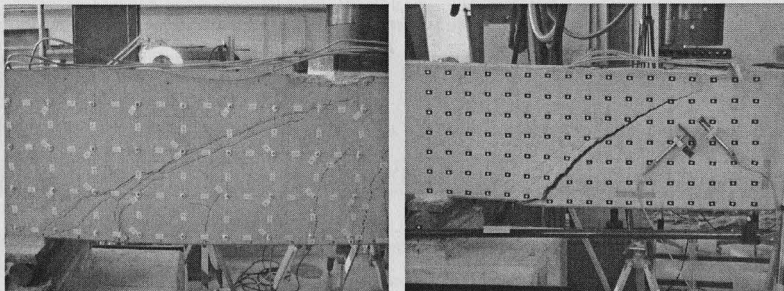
Rissbildung bei Erreichen der Traglast links Balken G03 und rechts Balken G04
